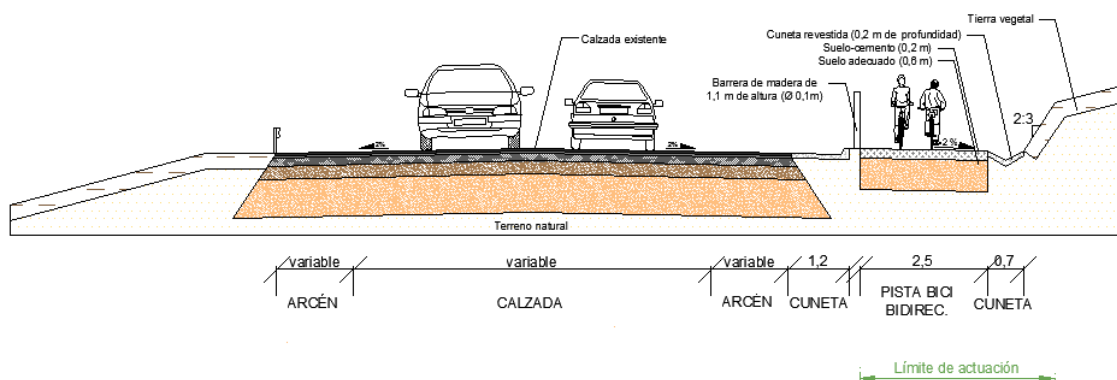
Sección tipo ST-5.1: Tramo 5. Pista bici bidireccional. Sección desmonte
